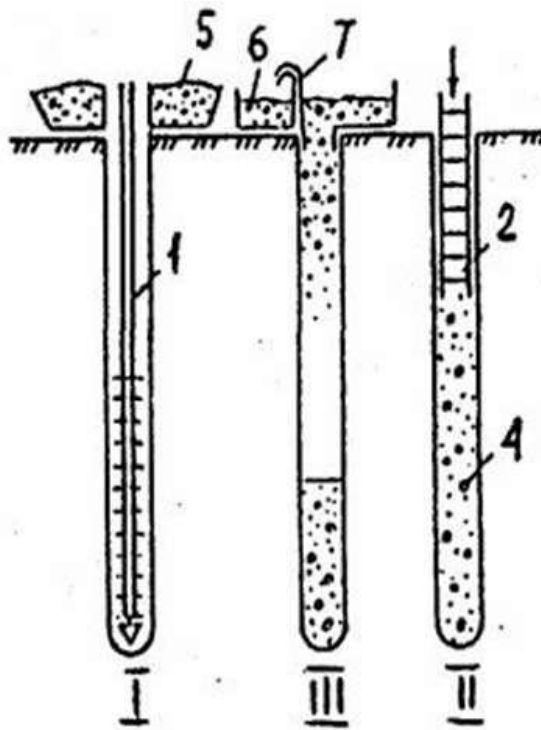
Влаштування буронабивних паль: 1 – буровий став; 2 – армокаркас; 5 – бункер для вибраного ґрунту; 6 – бункер для бетону; 7 – вентиляційна трубка.
